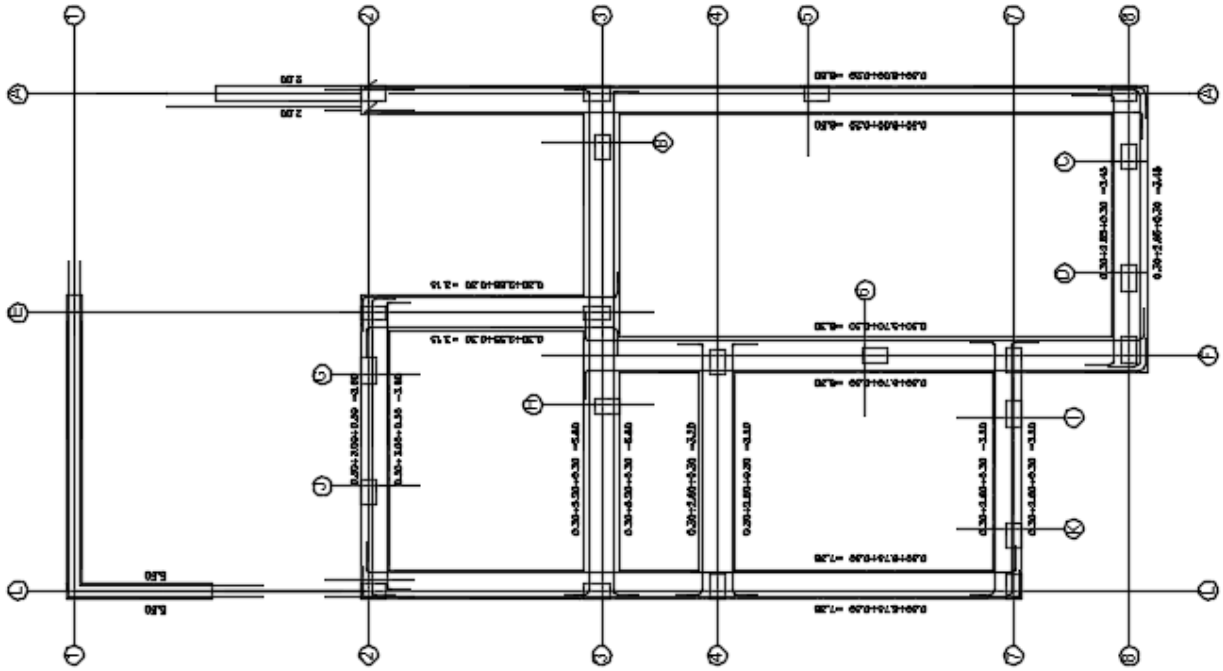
Planta refuerzo longitudinal vigas de cimentación.
